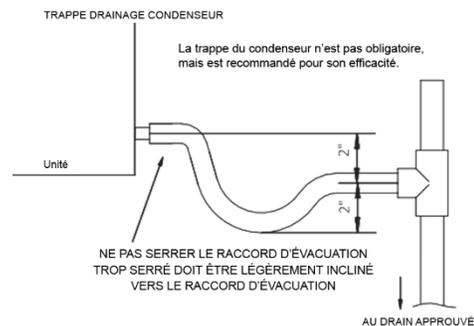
INSTALLATION DE LA CONDUITE DE DRAINAGE
